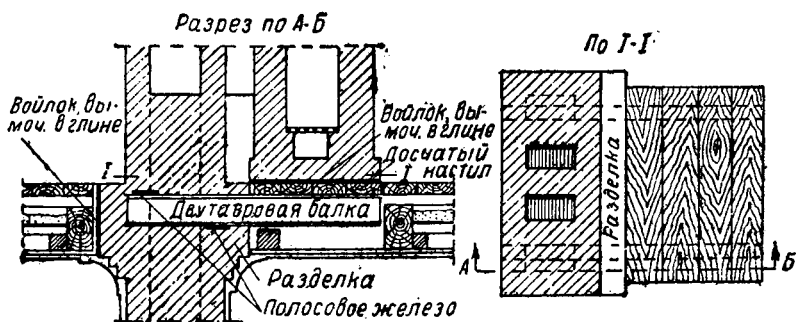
Установка печи второго этажа на консольной двутавровой балке.
